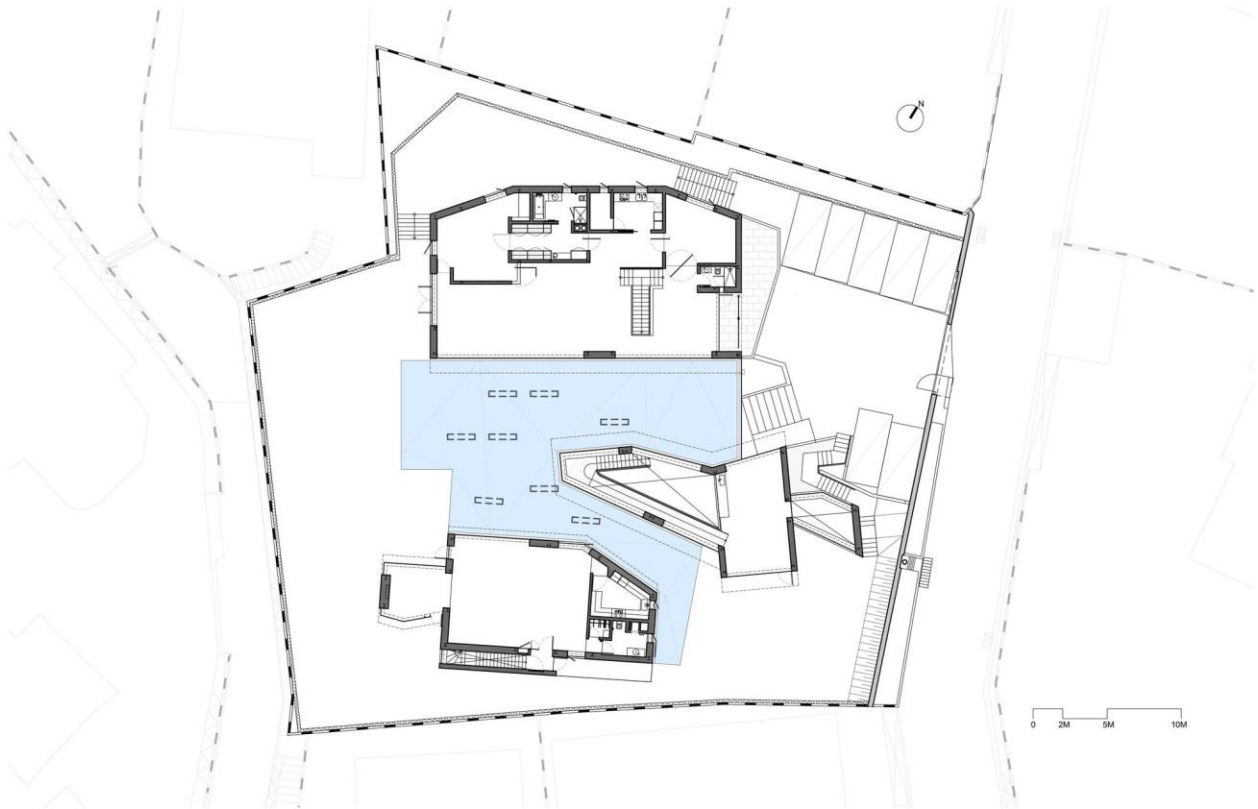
Planta. Galería y casa Daeyang, Fuente: Steven Holl architects
